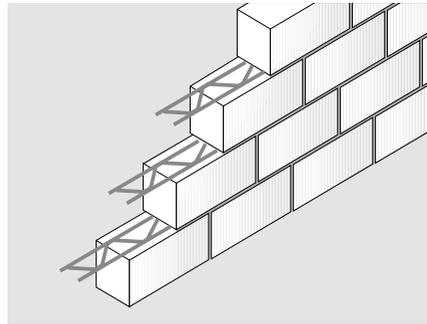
/53: Korrosionsgeschützte, konstruktive Lagerfugenbewehrung für erhöhte Rissesicherheit
